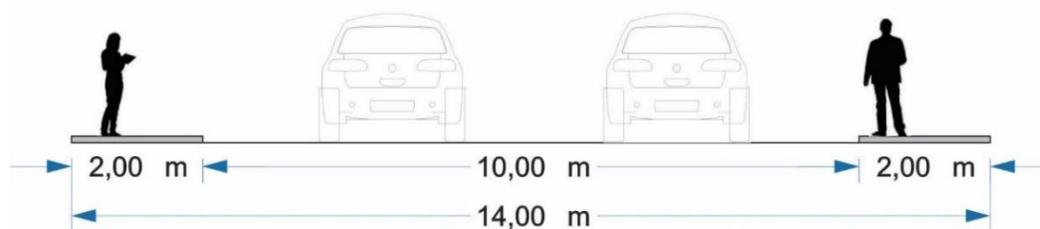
Levantamiento perfiles vialesFuente: (Elaboración propia, 2020)
